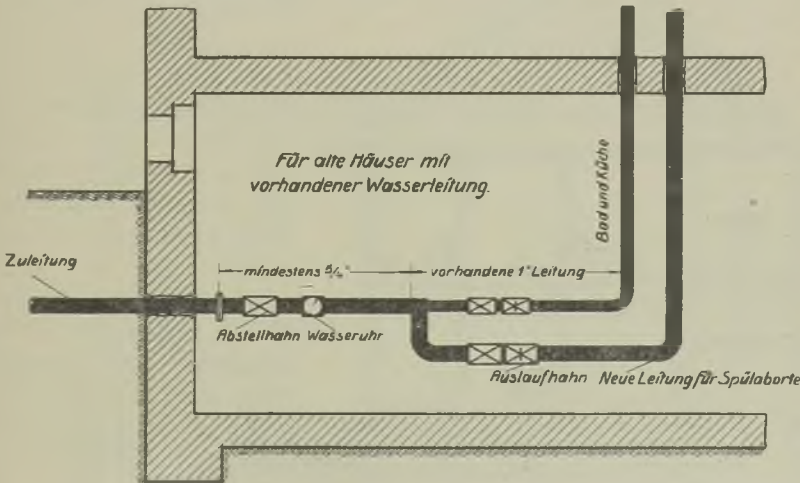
Nachträglicher Einbau der Leitung für Spülaborte. Die alte Wasserleitung ist zu schwach. Deshalb müssen weitere Röhren installiert werden. 1. Zuleitung: statt 25 mm Rohrdurchmesser sollte mindestens 32—38 mm Rohrweite neu verlegt werden bis zum Abzweig der neuen Leitung für die Spülaborte. 2. Neue Steigleitungen für die Spülaborte mit 32 mm Rohrdurchmesser. 3. Als Platz für den neuen Wassermesser muß vorgesehen sein: bei Wassermesser von 15—30 mm lichter Weite = 500 mm, bei Wassermesser von 40 mm lichter Weite = 650 mm.
